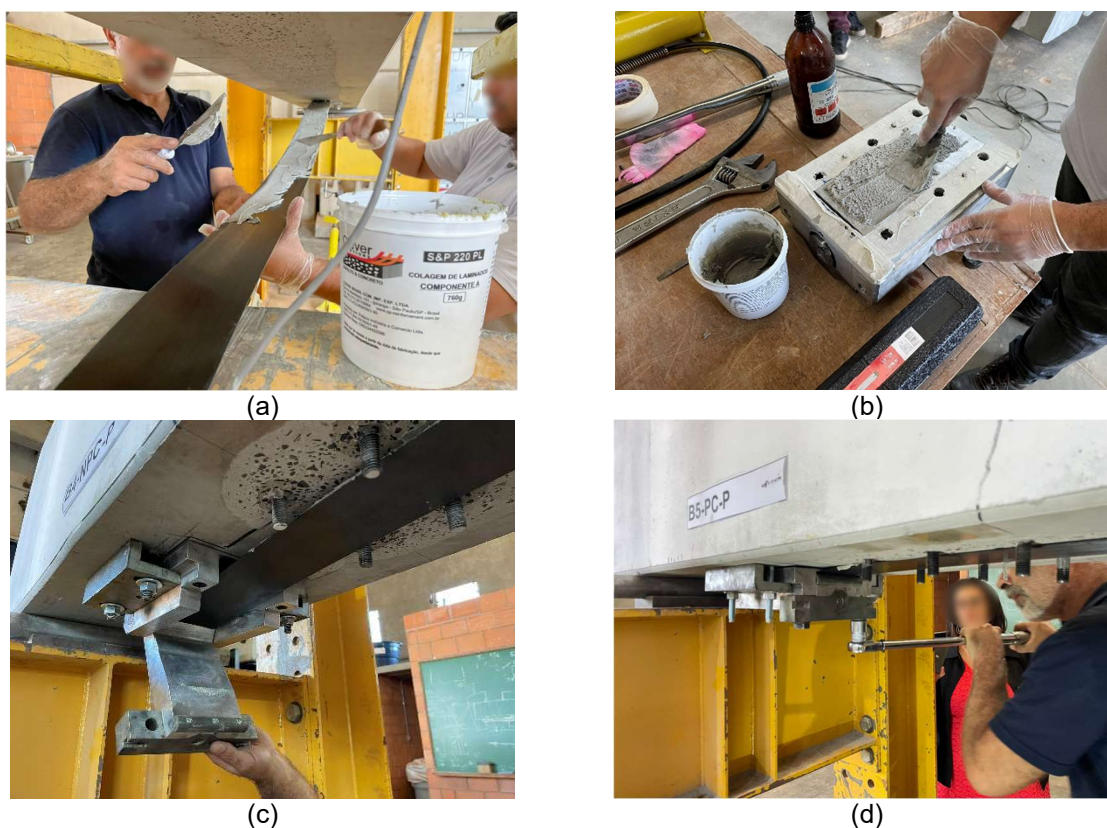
Preparação da moldura metálica e cilindro hidráulico
